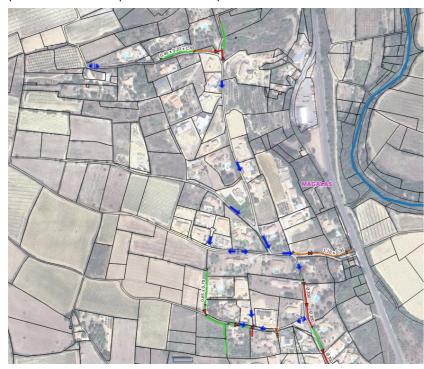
Extrait du plan des réseaux pluviaux – secteur du Vic
